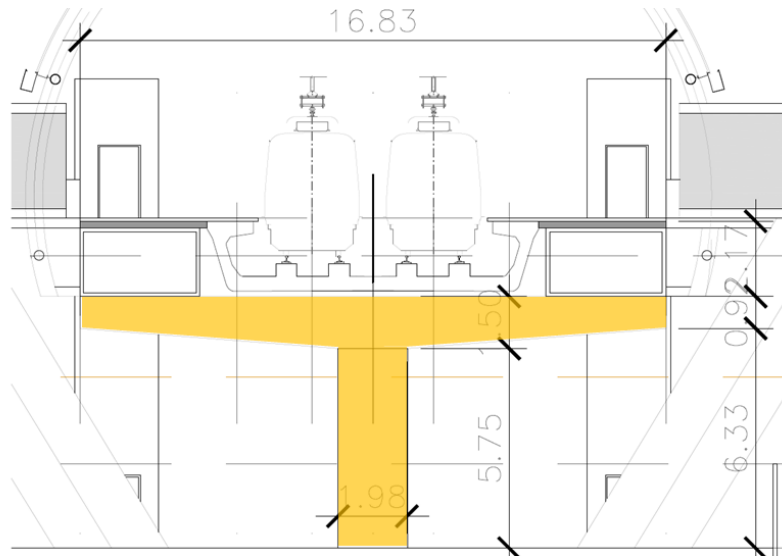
Detalle de estructura del cajón y capitel extendido de la estación elevada
